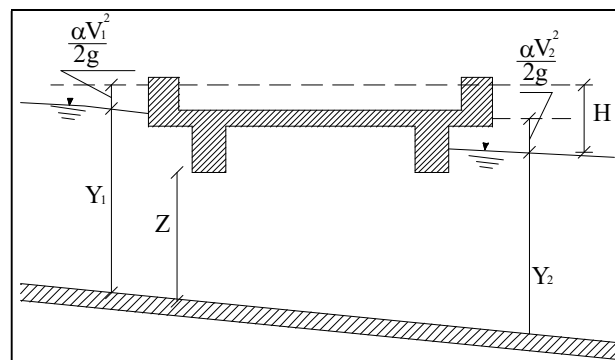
Sezione schematica di un ponte – Schema di calcolo
